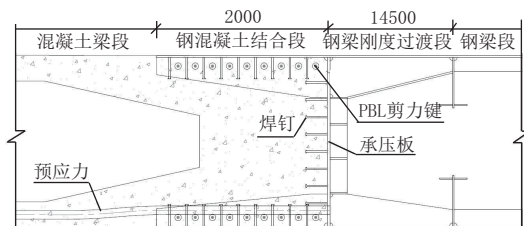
轻型钢-混凝土过渡段纵剖面图(单位:mm)
